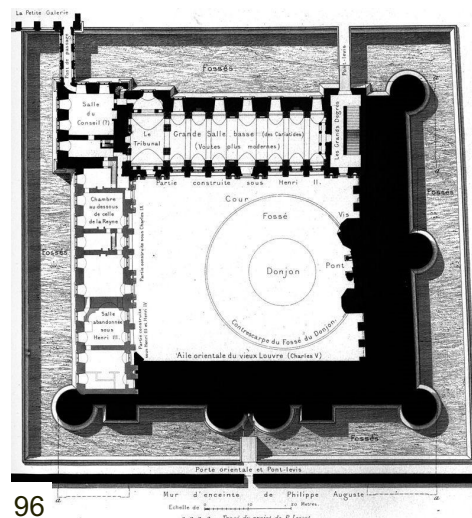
Grundriss des Renaissance-Louvre mit dem Lescot-Flügel oben und dem Südflügel links.
